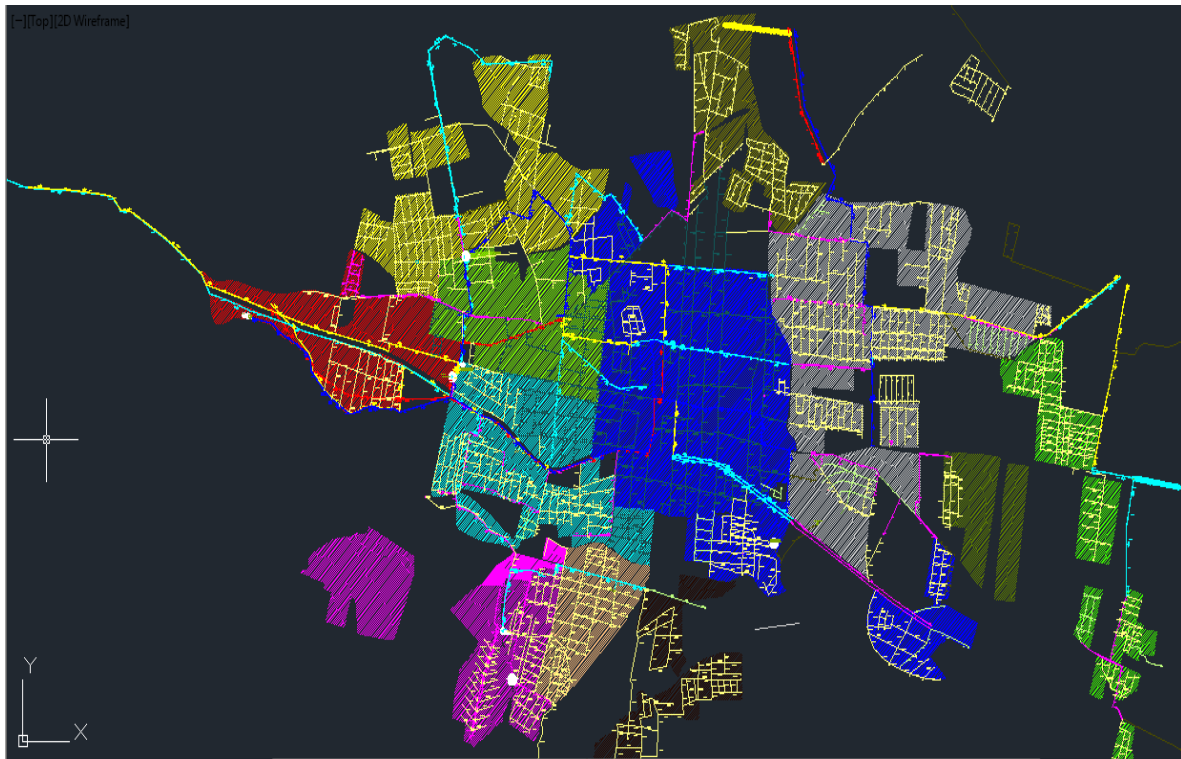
Plano de propuesta a sectorizar del SAPA.
